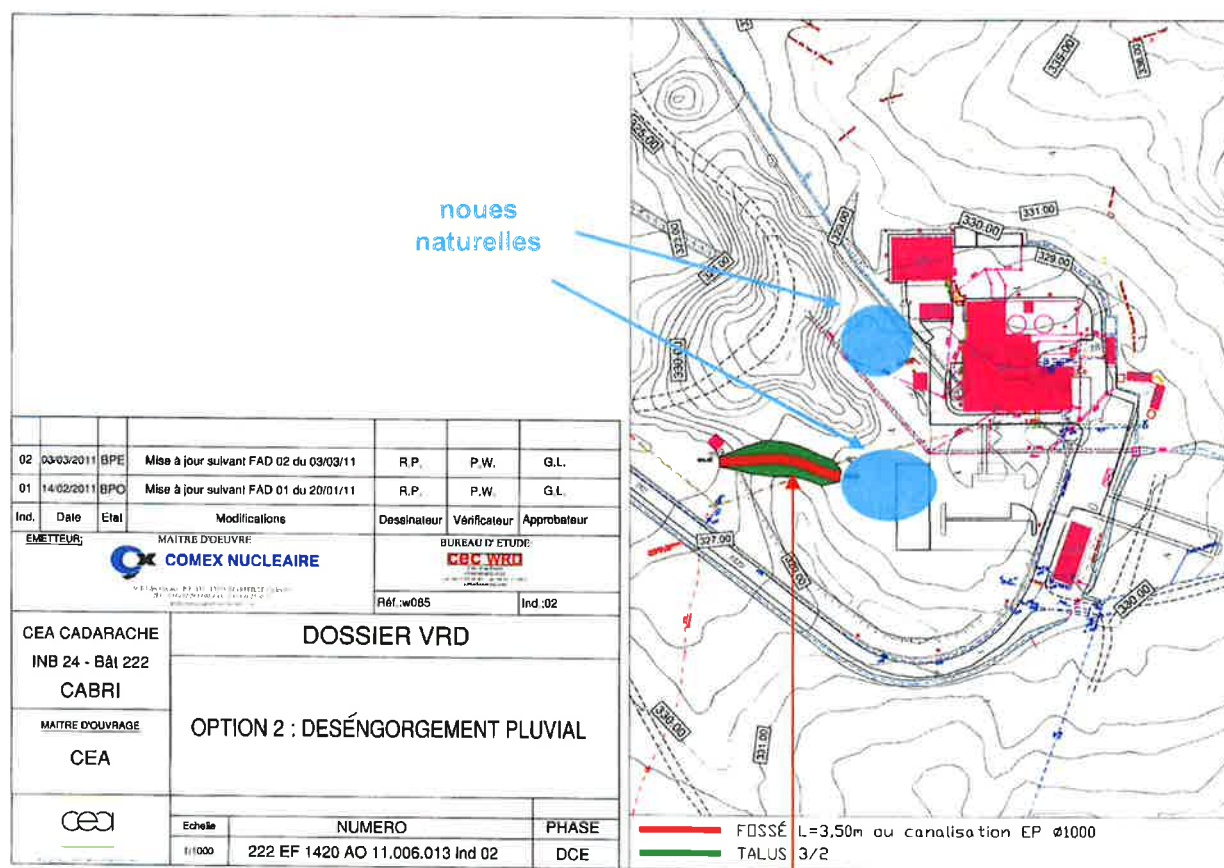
Plan de projet de la réalisation d'un second exutoire pluvial
